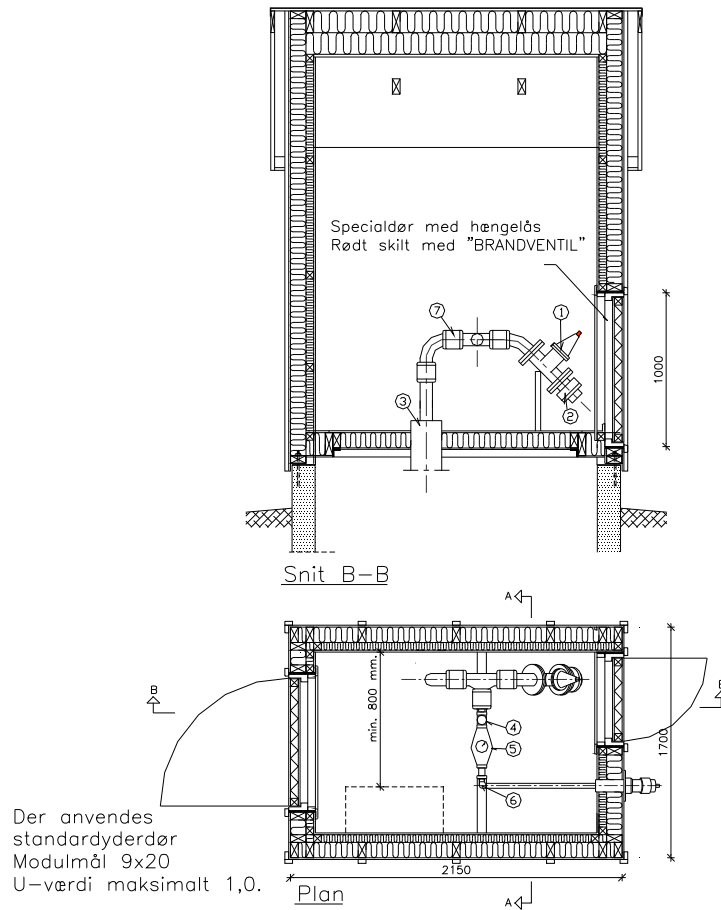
Taphus ekstraisoleret, snit B-B og plan.
